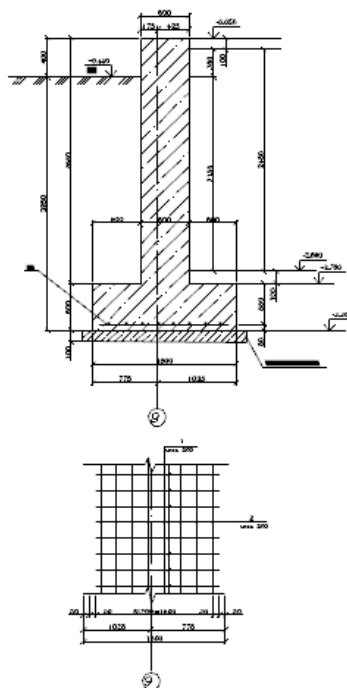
Схема для определения арматуры в фундаментной
